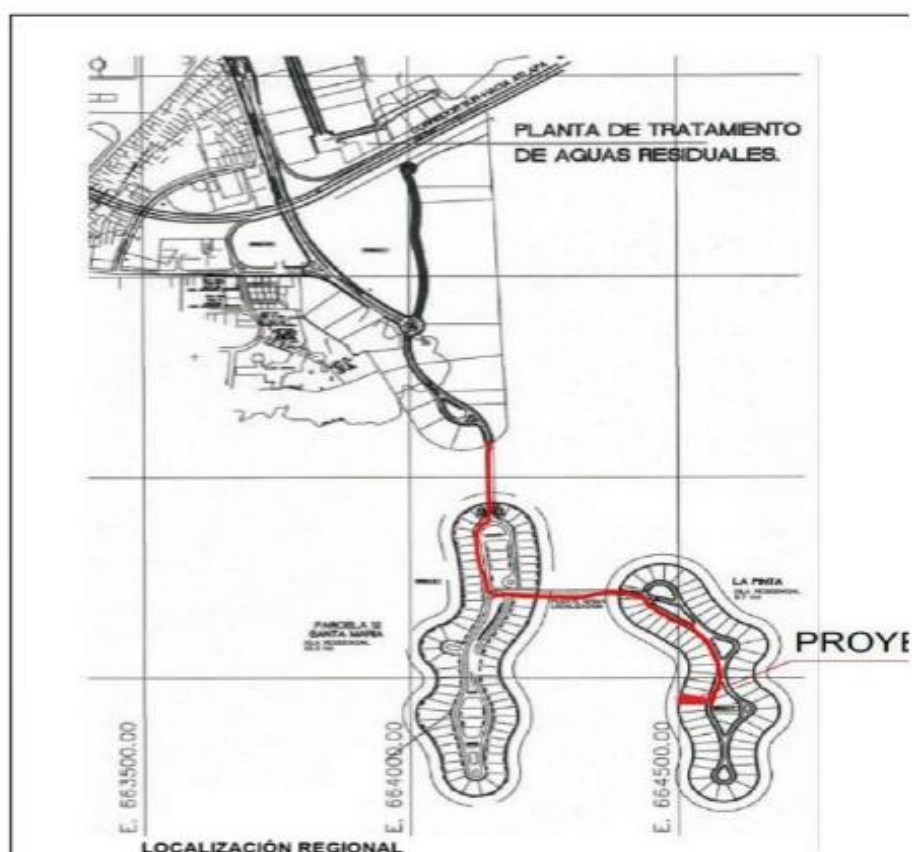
y 3. Vía de acceso al área sobre el lote 15, donde se construirá el Proyecto SOLEIL LUXURY RESIDENCES.
